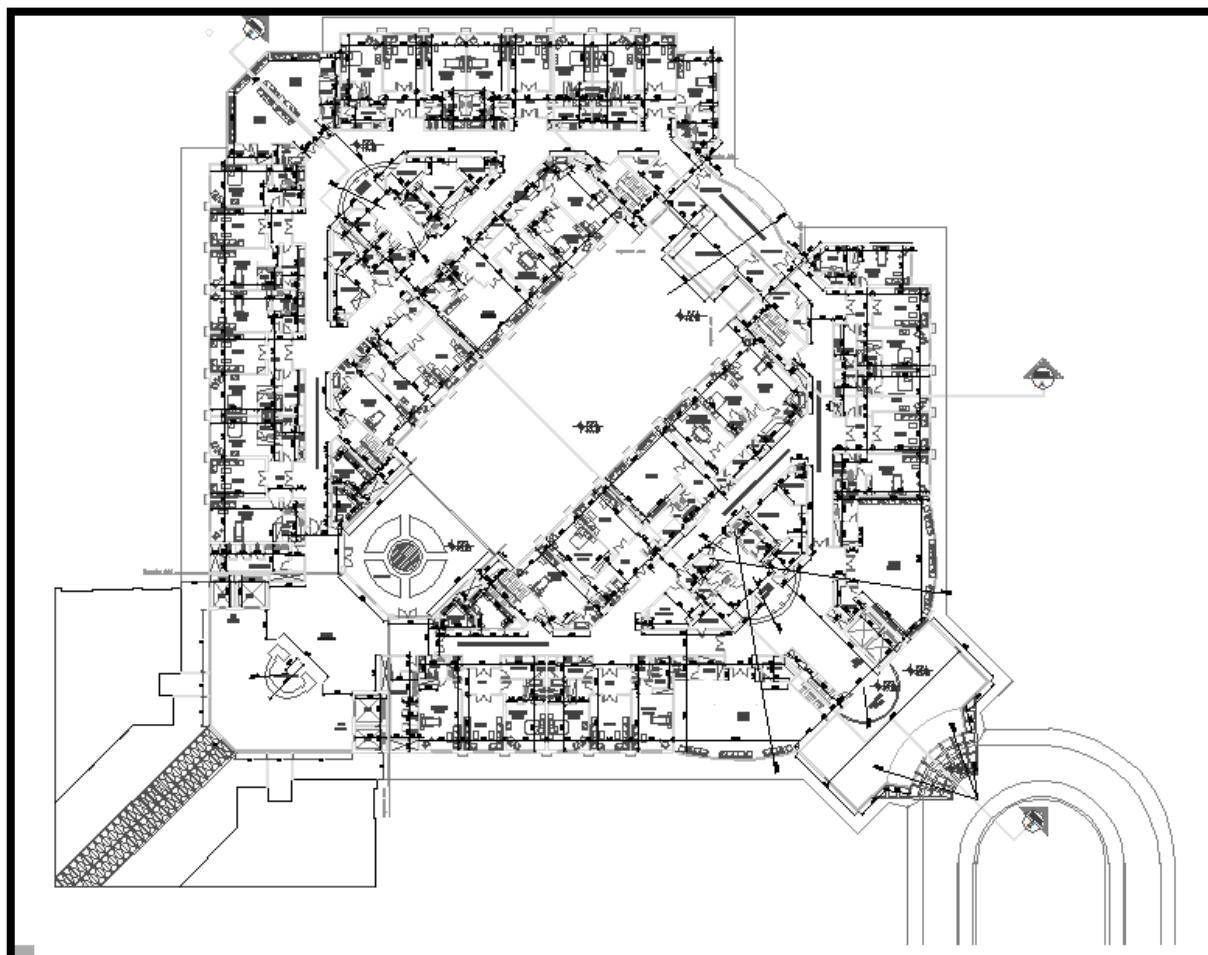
المسقط الأفقي للطابق الأول.
